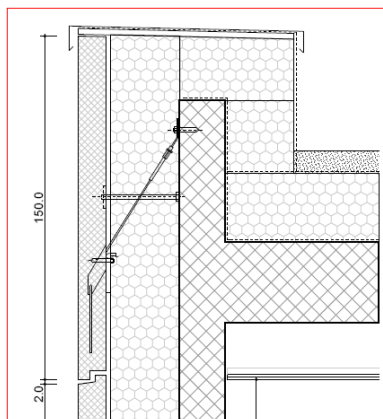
Detalhe do isolamento da ligação da fachada com o terraço, onde o isolamento está definido pelo exterior.
